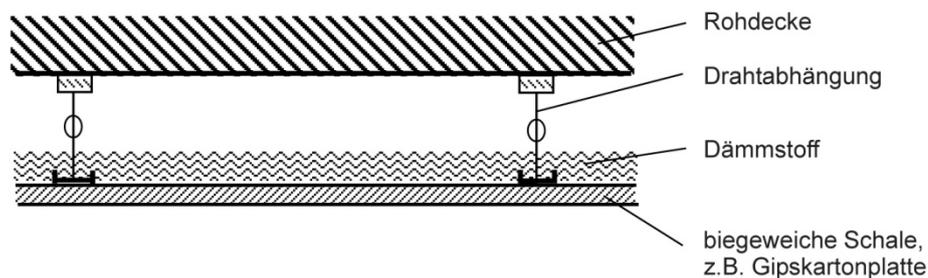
Prinzipaufbau einer biegeweichen Unterdecke⁷²
